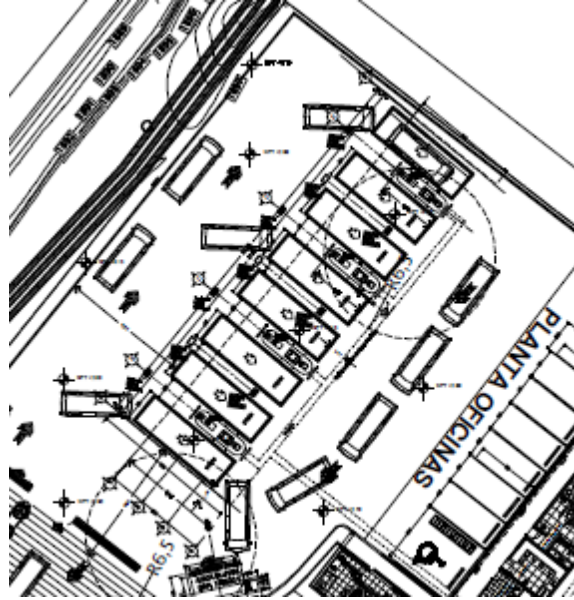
Planta de conjunto patio de servicio y estacionamiento
